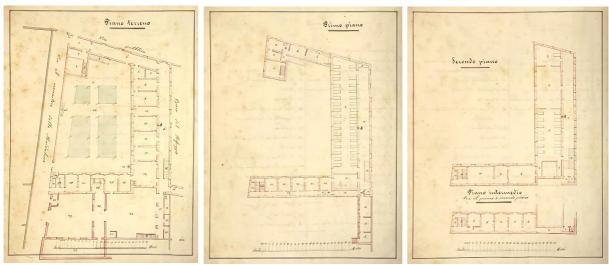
Ospedaletto di Santa Filomena, [early 20th century] (AAOPB, sezione VI, Planimetrie, stampe, disegni e manifesti, VI.3.6.1-11)
